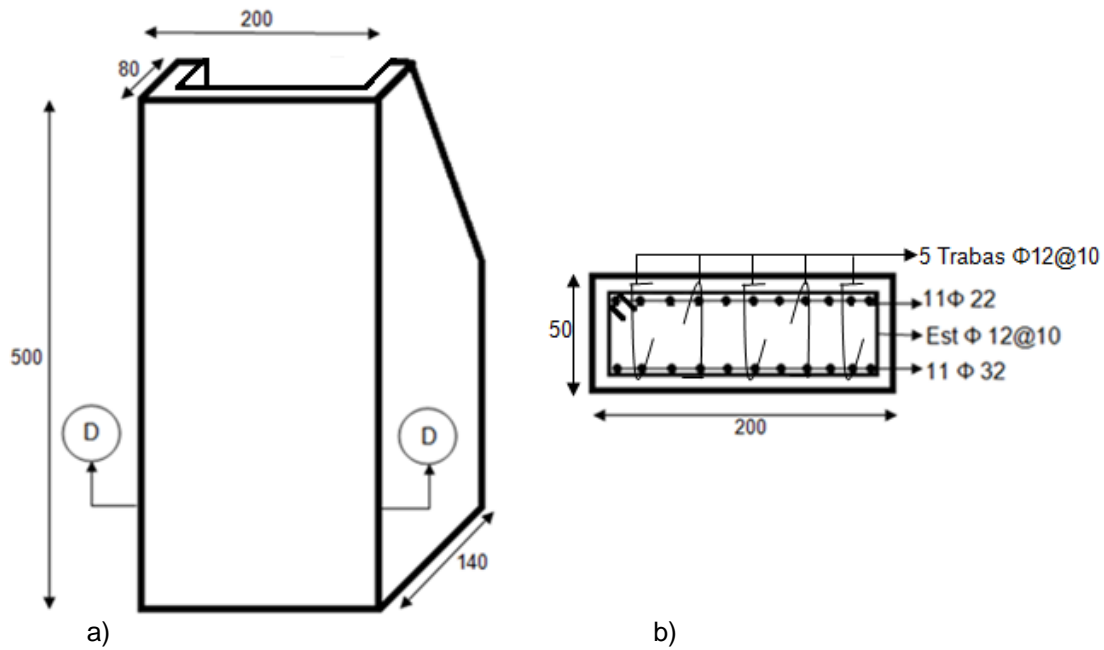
a) Vista frontal muro cerro. b) Sección D-D.
